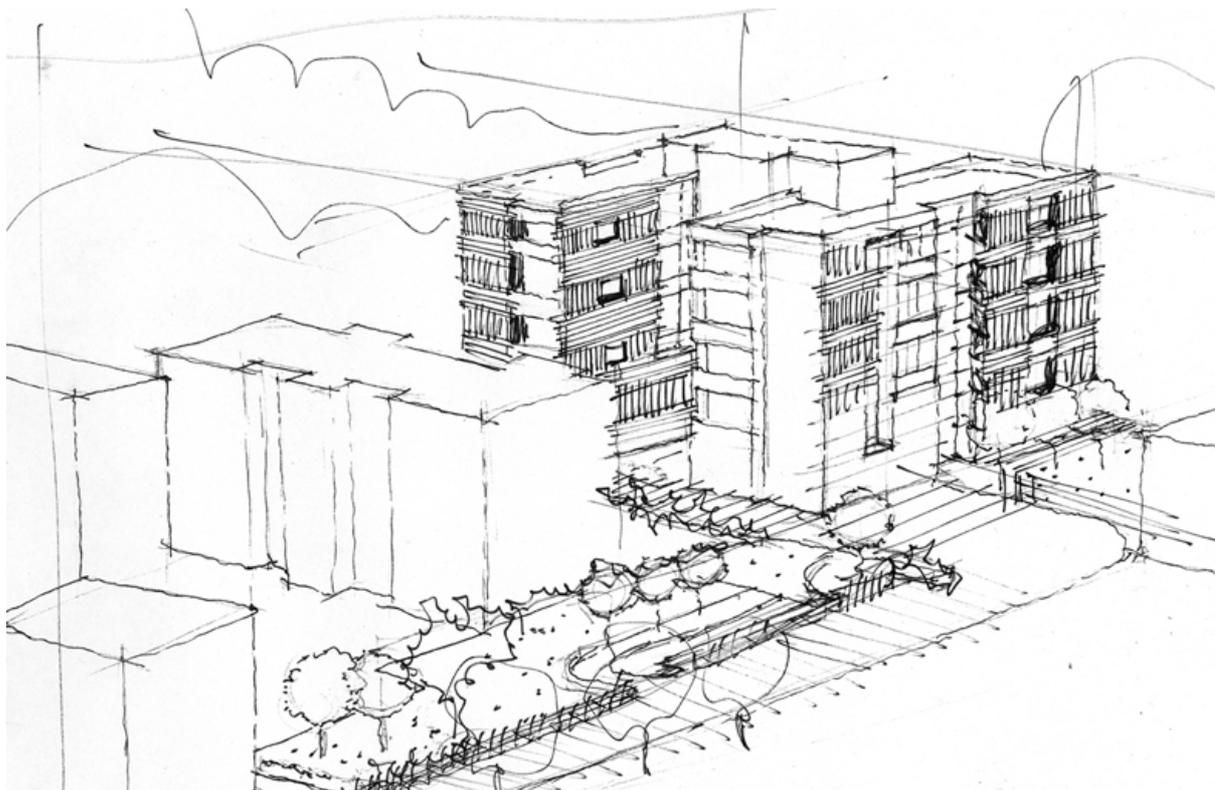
Edificio in via Palazziello (Soccavo) – Schizzo di progetto
